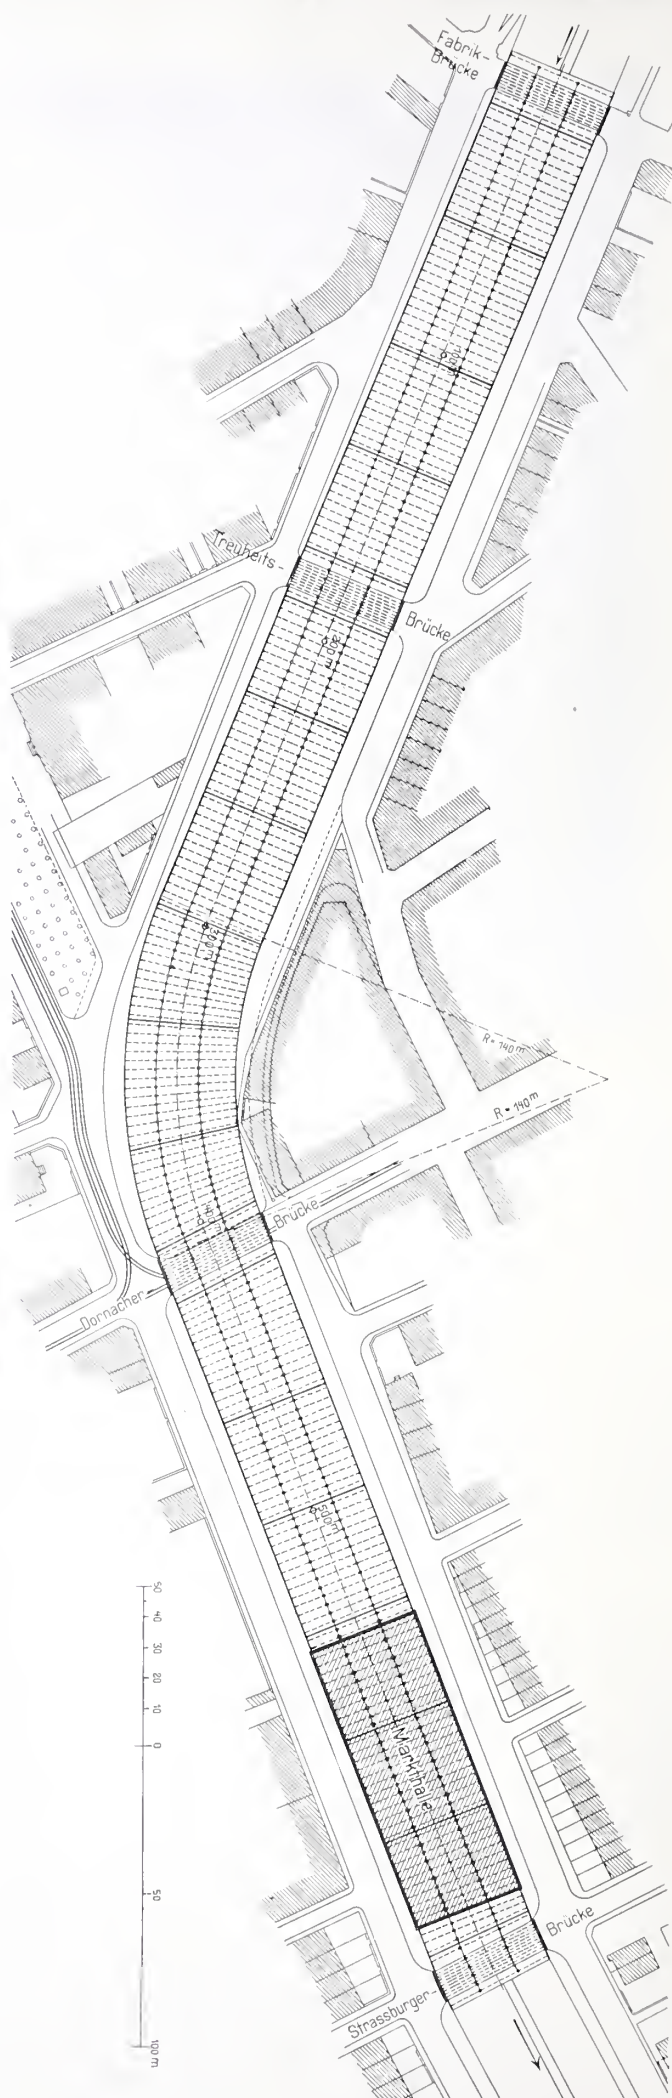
Lageplan der Kanalüberdeckung. — Masstab 1 : 2500.
